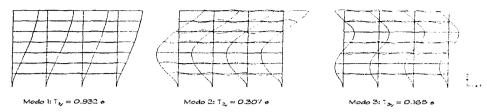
Vieta en elevación de las formas modales en dirección "Y", estructura de 7 niveles discñada en zona !!!
